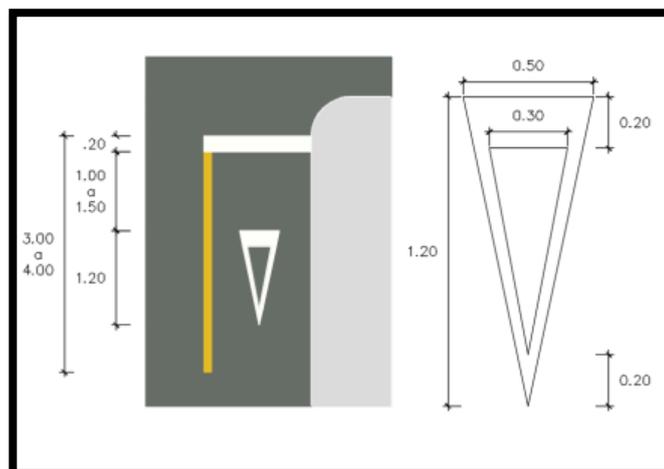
Dimensiones de demarcación en el pavimento Pare
